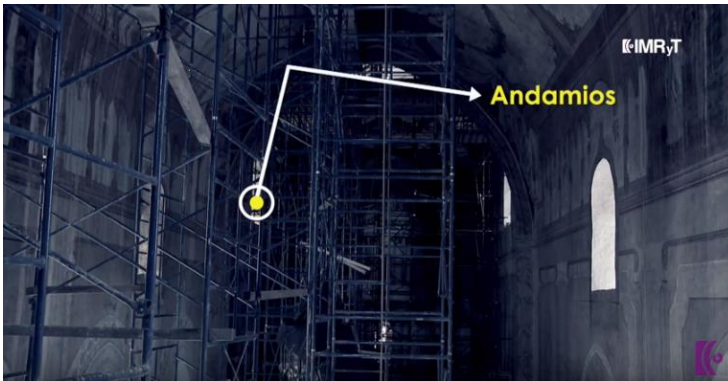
Trabajos de reconstrucción, Colocación de andamios interiores para apuntalar y reparar fisuras en la bóveda. (Monzalvo, 2019).
